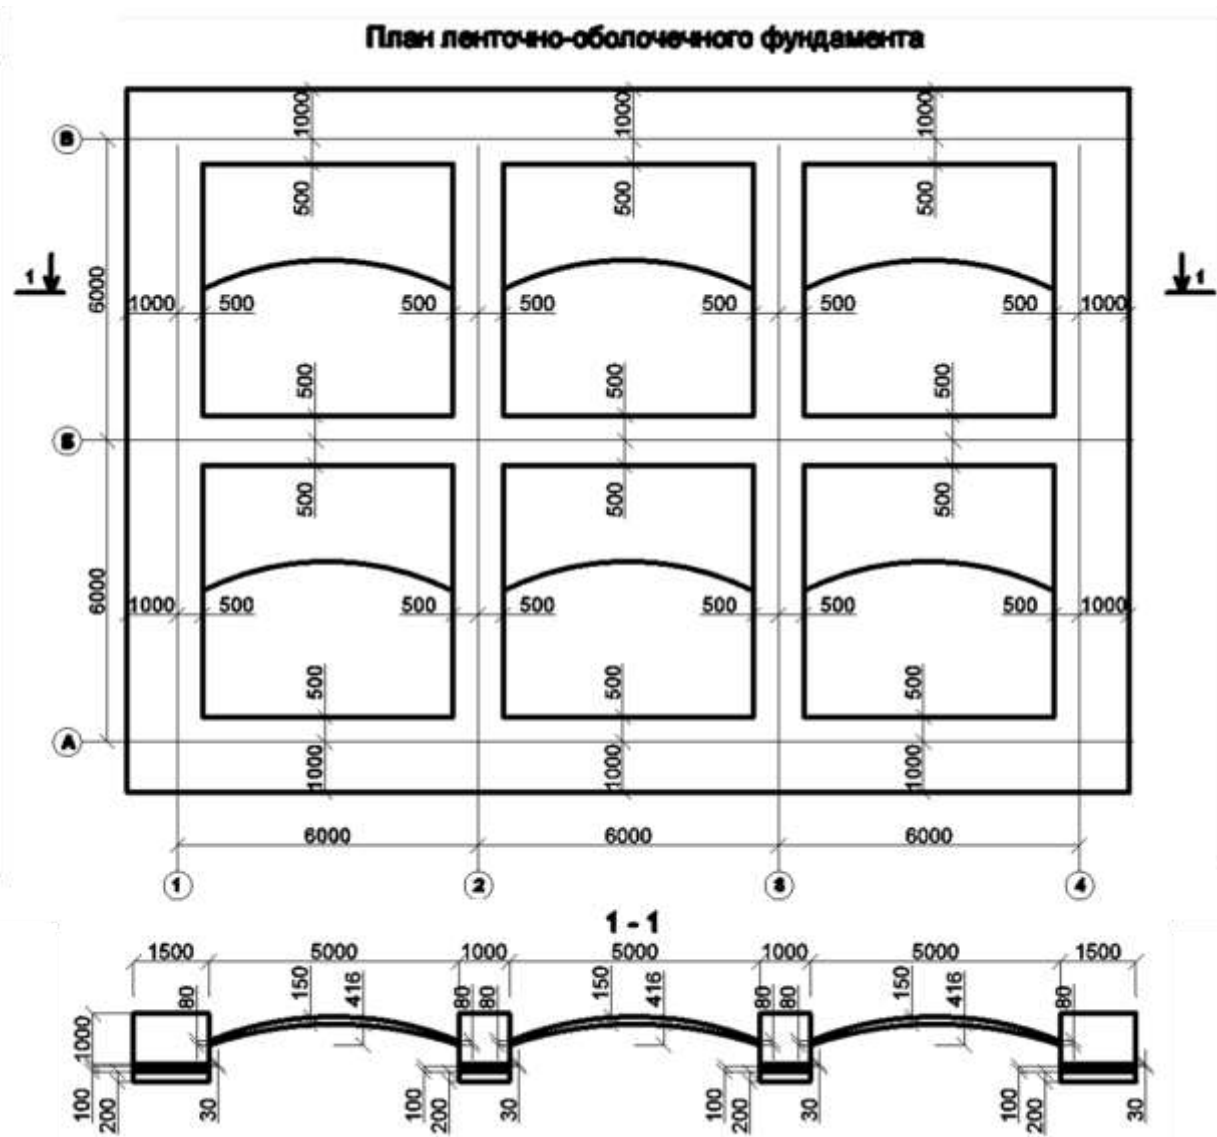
План и разрез ленточно-оболочечного фундамента
